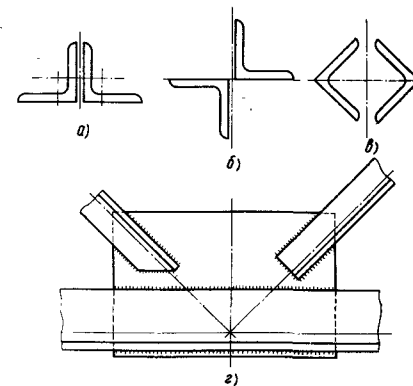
Узел примыкания раскосов к поясу из сдвоенных уголков
